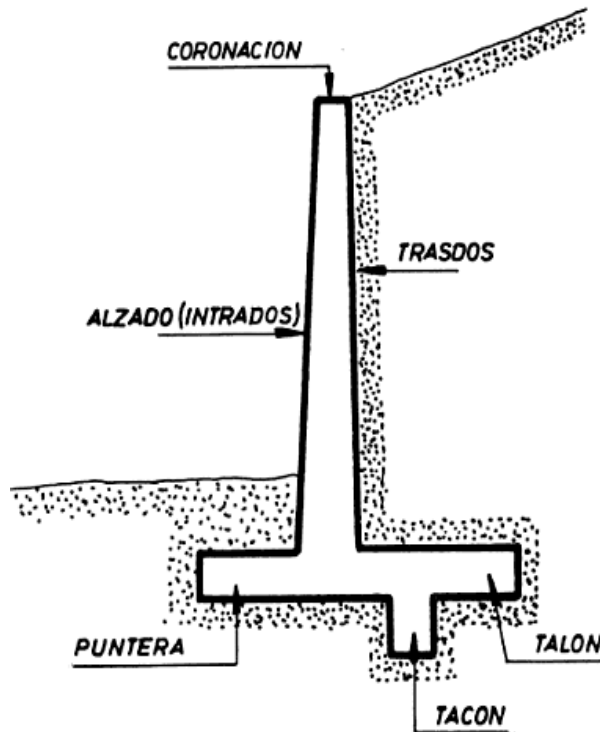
Muro de concreto armado (Barros; 1947:12)
